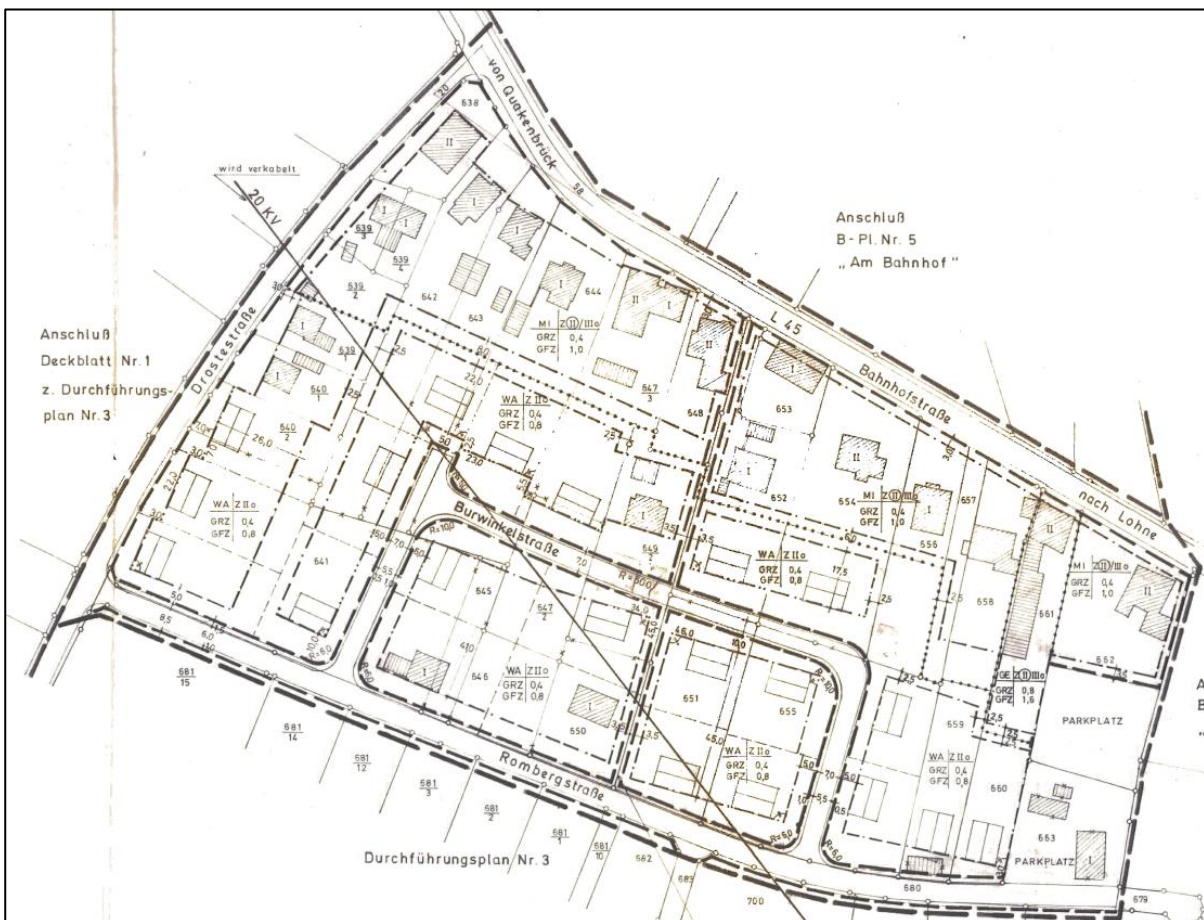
Bebauungsplan Nr. 25, Stand 1971 (ohne Maßstab)
